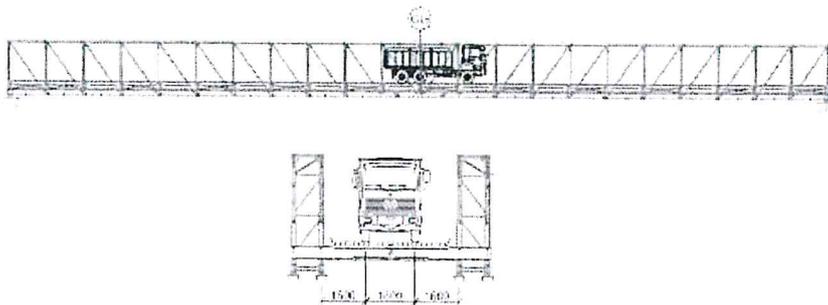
POSICION DE LA CARGA DEL ENSAYO (ALZADO Y CORTE TRANSVERSAL)
